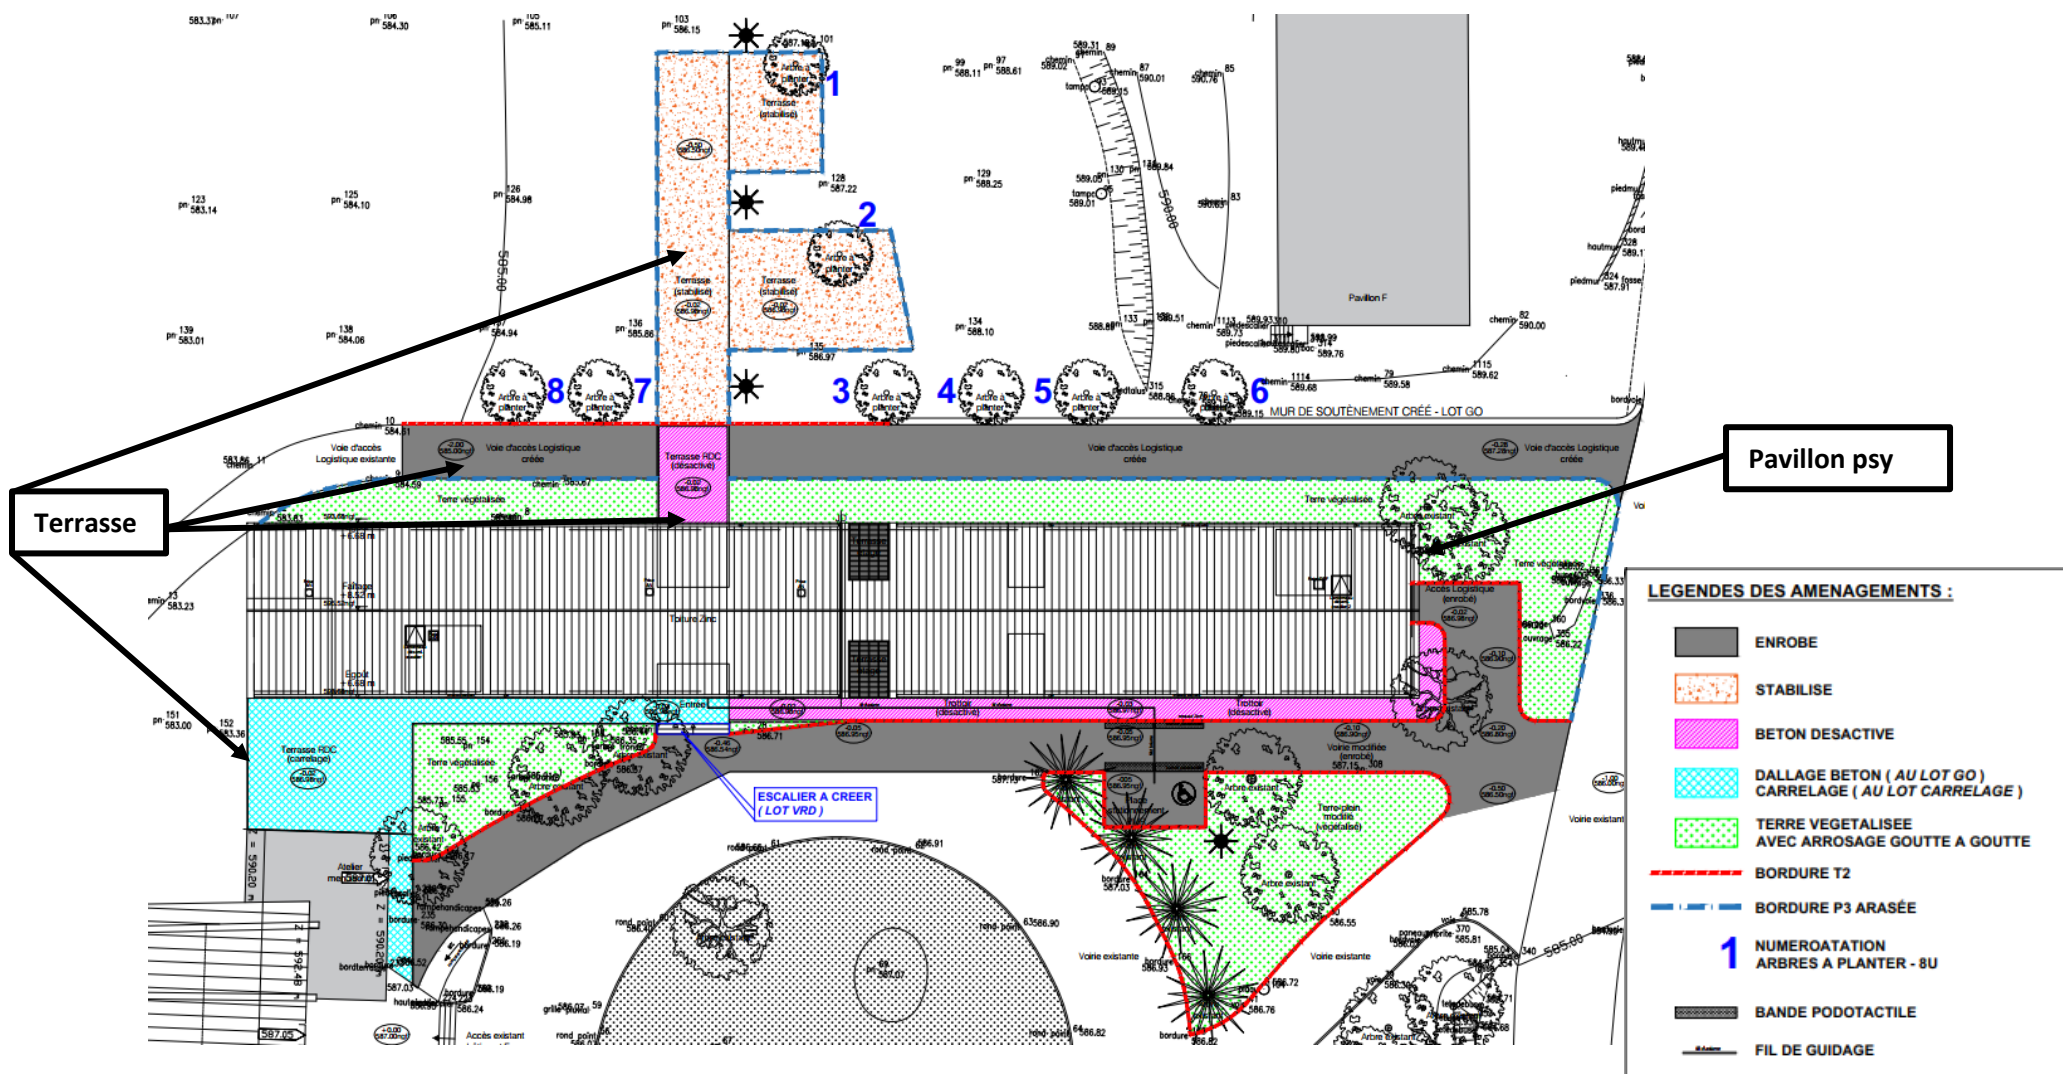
Plan de masse du projet (source : Atelier 3a, 2022)
